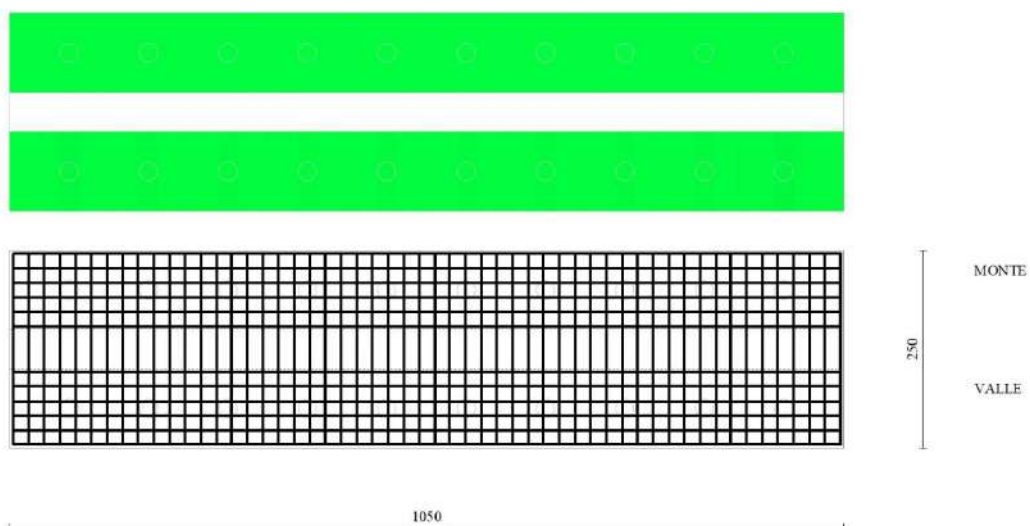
Piastra fondazione dir. X (Inviluppo)
